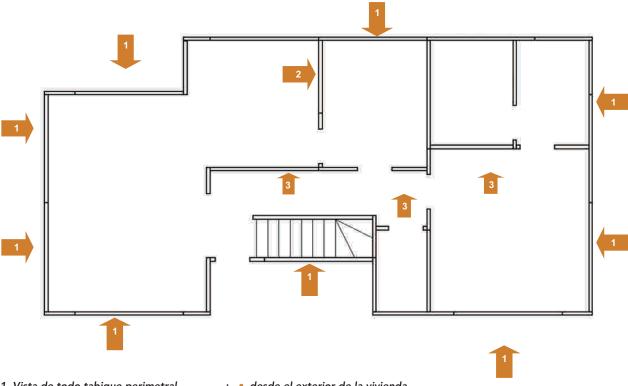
64: Plano planta de arquitectura del primer piso con distribución de recintos.
